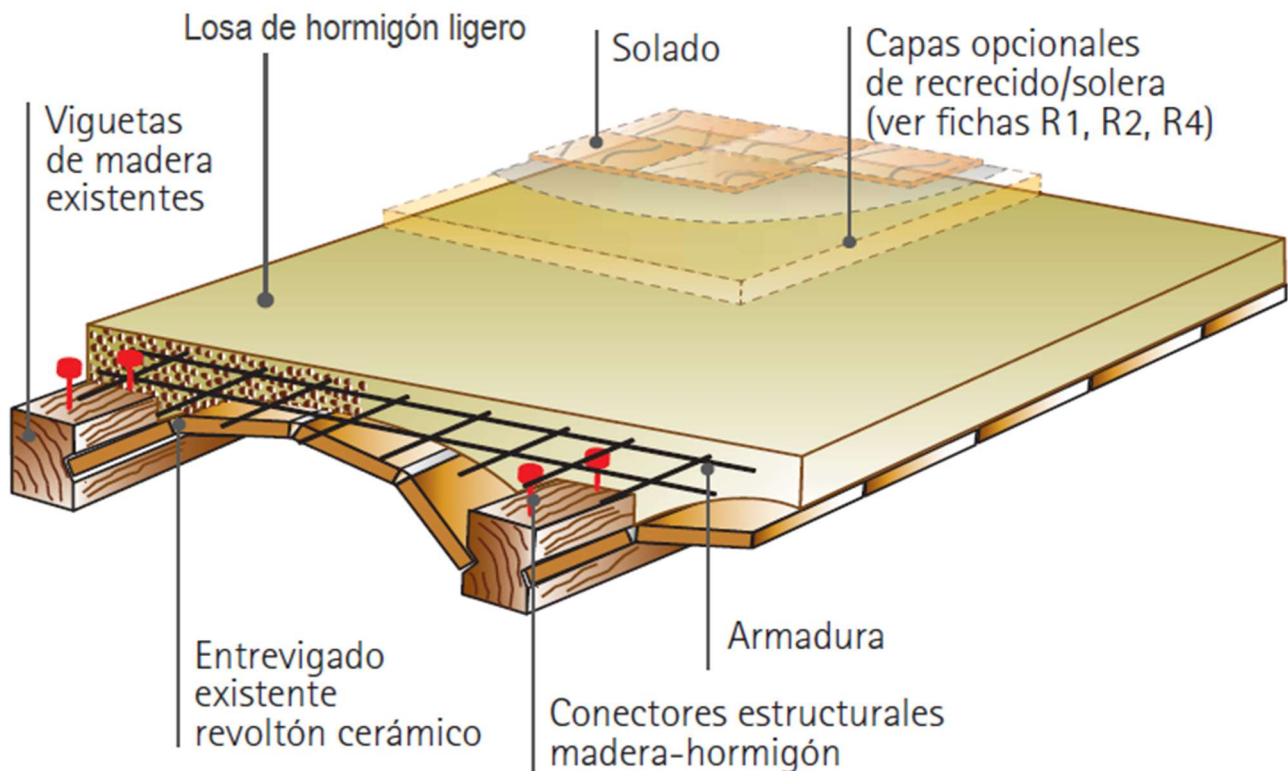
Esquema del nuevo forjado de madera con entrevigado cerámico.
